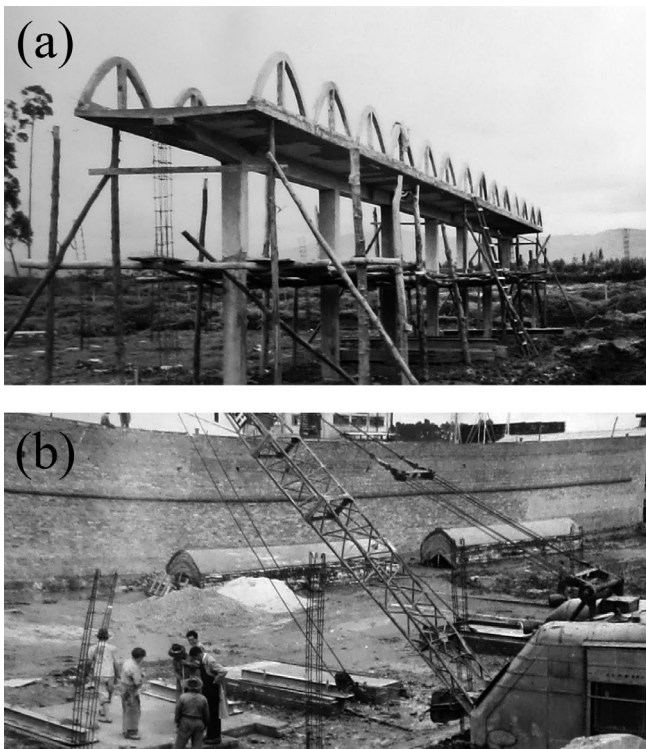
(a) Losa de apoyo de las membranas de hormigón en la fábrica de jabón, Bogotá, 1954; (b) Campo de trabajo destinado a la fundición de los muros y las membranas mediante la técnica de hormigón al vacío. (Fuente: Fondo CINVA, Archivo Histórico de la Universidad Nacional de Colombia, caja 175).
